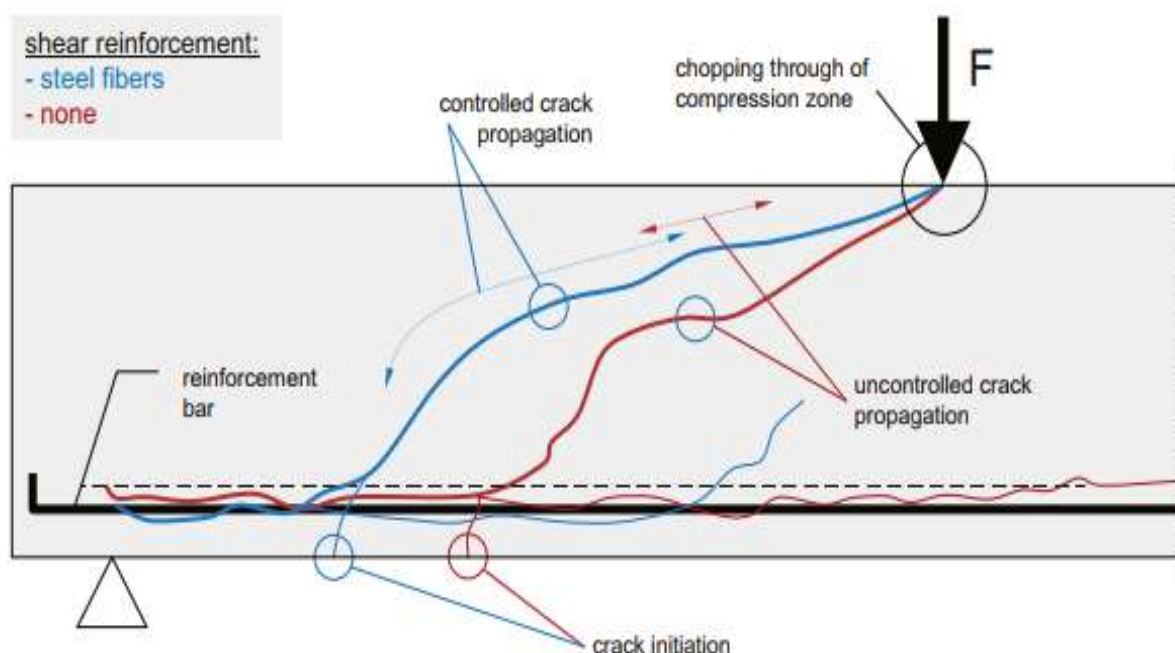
Comportamiento de la fisura al corte en una viga sin refuerzo y con refuerzo con fibra de acero
